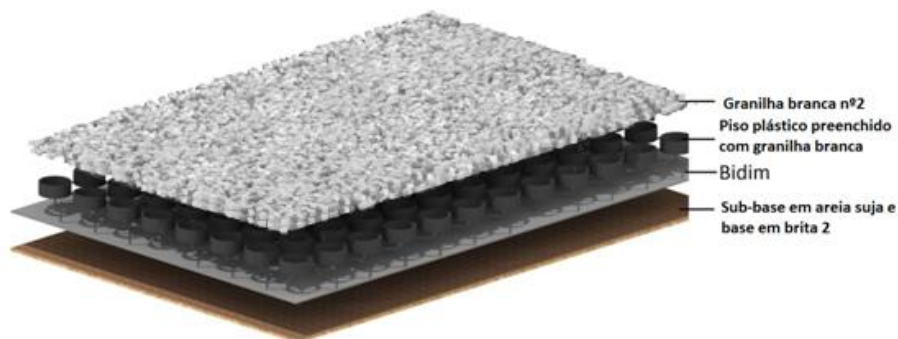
Detalhe genérico de implantação de piso plástico drenante.
